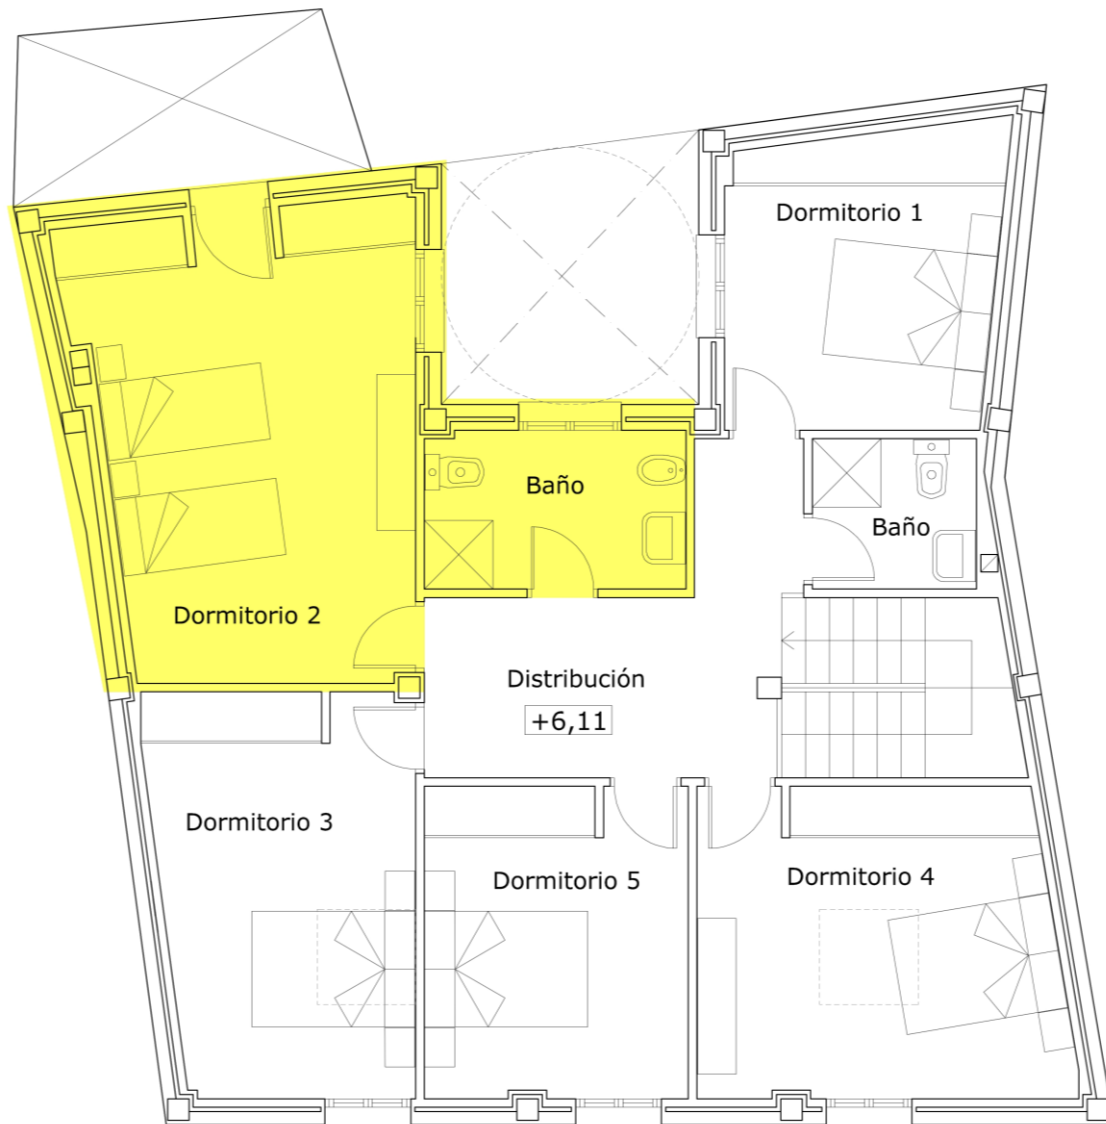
Plano de las zonas de actuación en planta bajocubierta.
